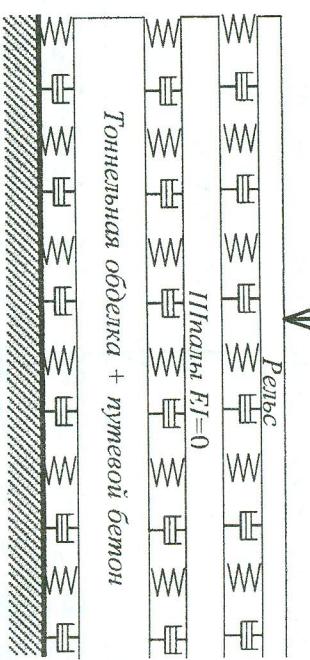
Путь с подшательными подкладками. Расчетная схема, учитывающая деформативность путевого бетона, тоннельной обделки и грунта
